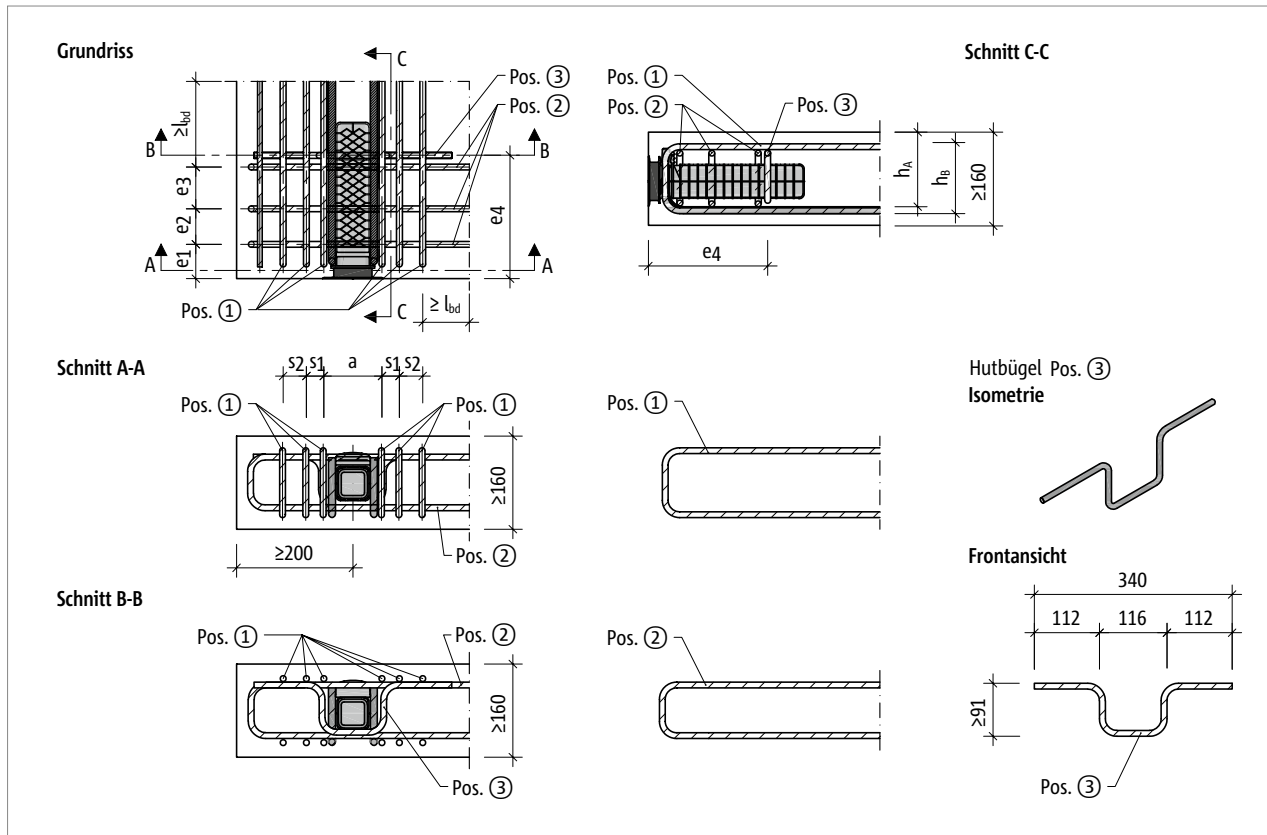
Schöck Tronsole® Typ P: Bauseitige Bewehrung
